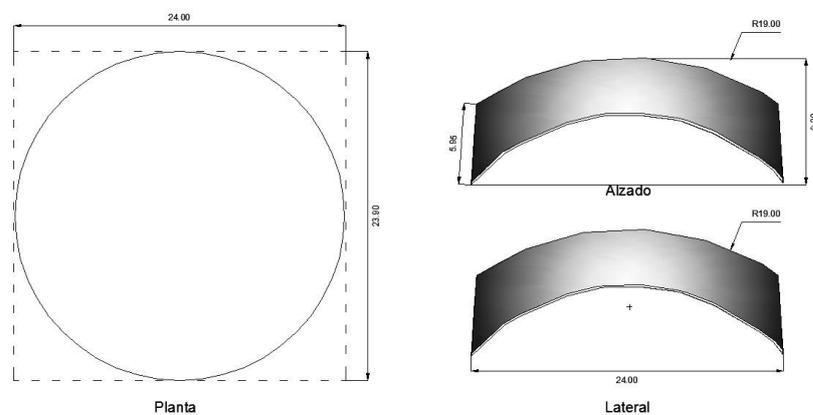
Detalle técnico Cascara de Hormigón Armado
